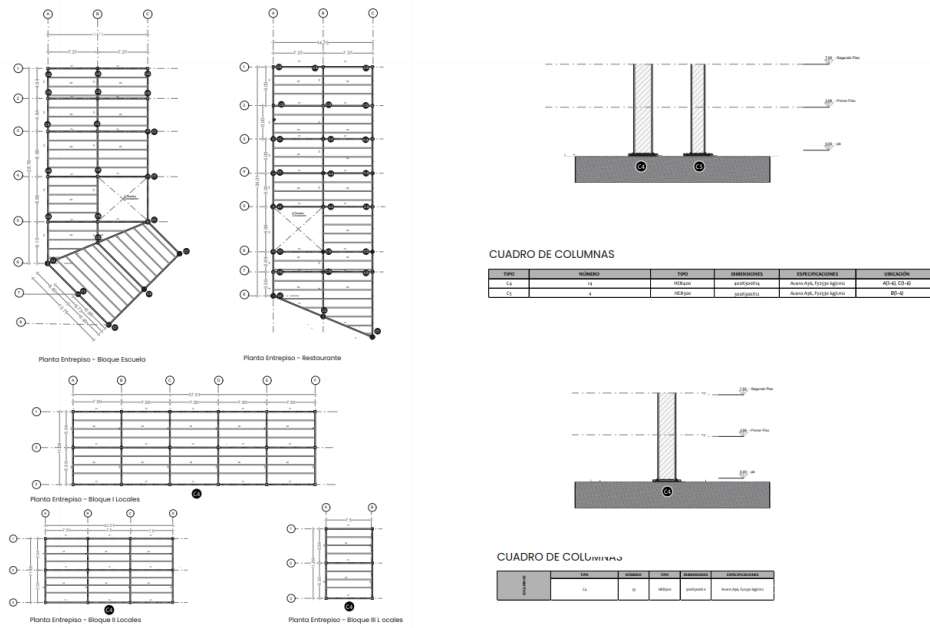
Cuadro de columnas rectangulares Ramires S 2023
